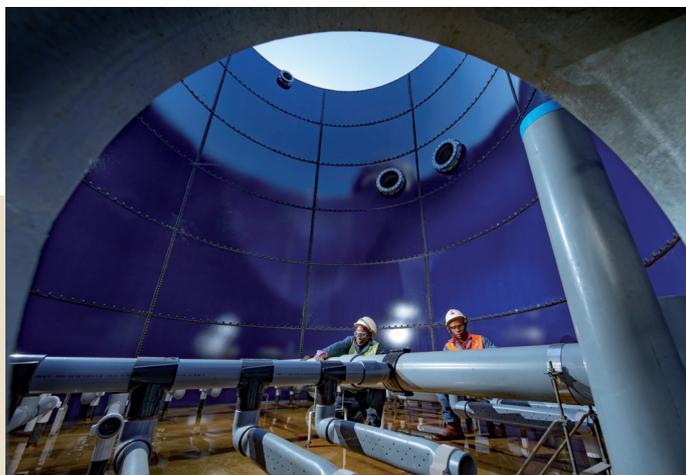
Glasfaserbeschichteter AGAR®-MBBR-Reaktor mit spezieller Belüftungstechnik und Hydraulik
